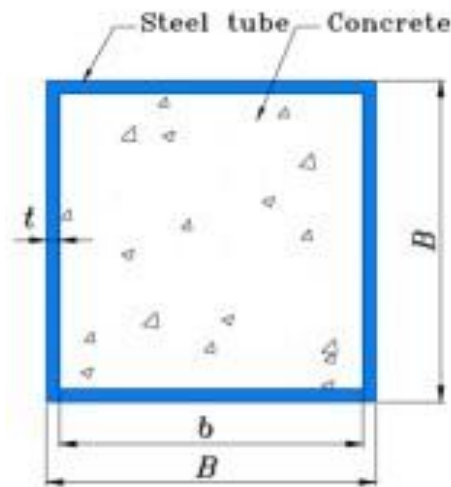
Tipo de columna compuesta, apoyo con núcleo en concreto y recubrimiento de perfil metálico. Adaptado de [6].
